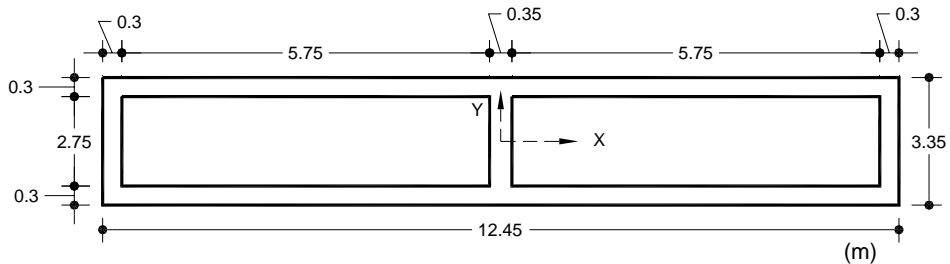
Sección 3 de la columna 11. (No. 11)
